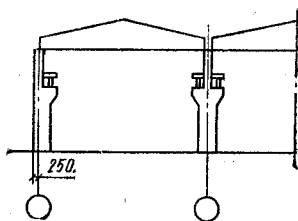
Привязка элементов конструкций к разбивочным осям на поперечном разрезе
